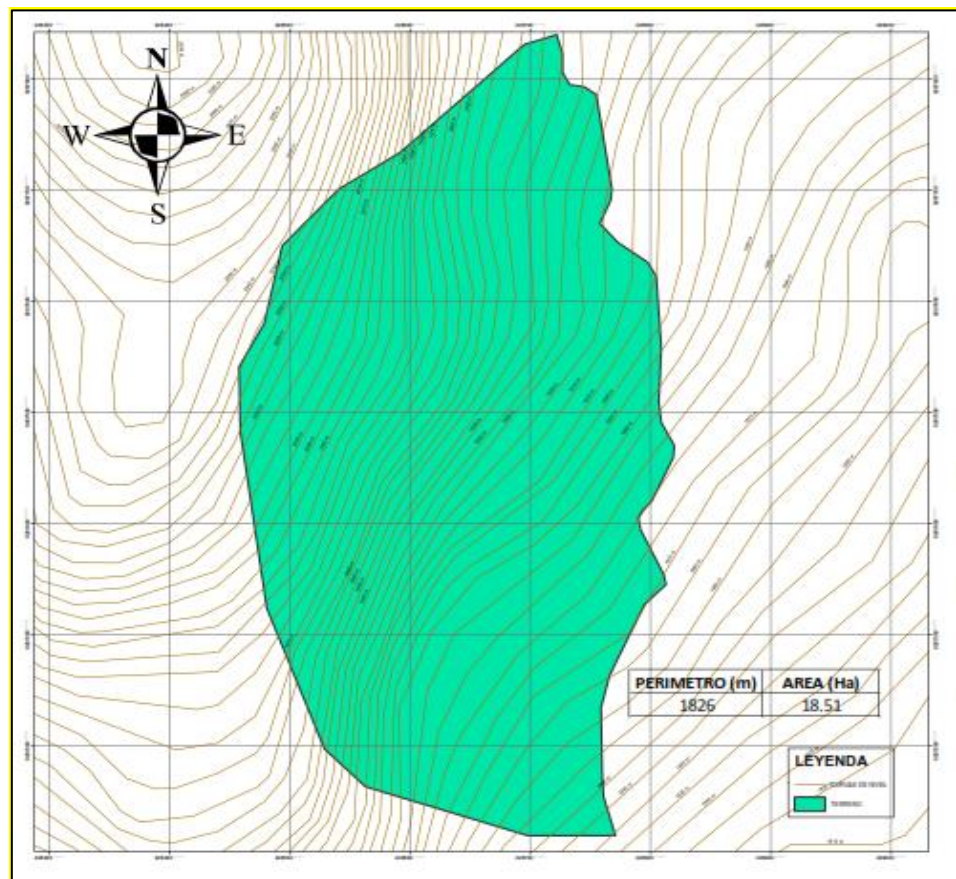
Plano de levantamiento topográfico de la alternativa 1: Santa Rosa.
